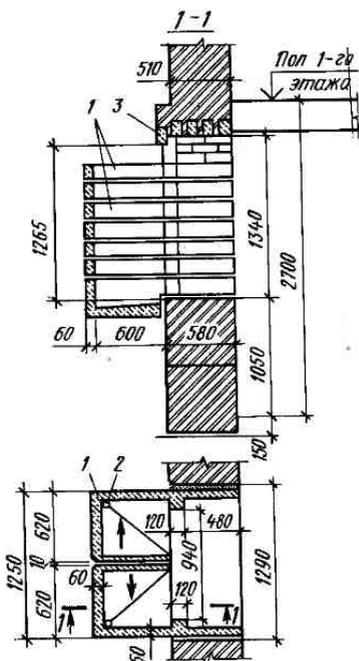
Приямок подвала из сборных железобетонных секций-консоль:
